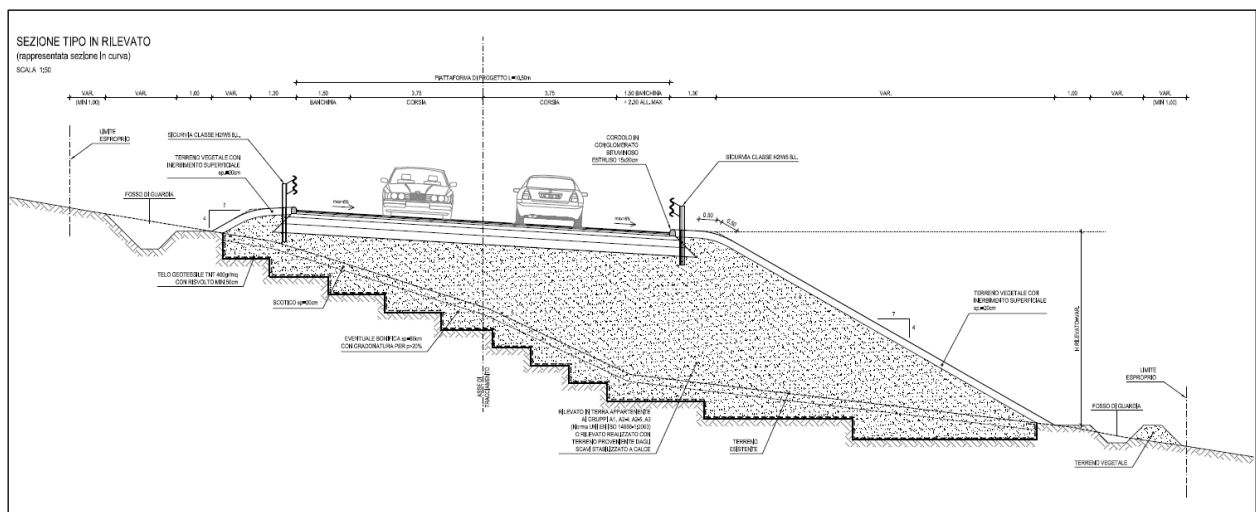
esempio di sezione trasversale tipica dell'asta principale.
